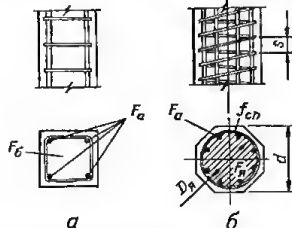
Армирование центрально сжатых железобетонных элементов: а — комутами (поперечными стержнями); б — спиральной арматурой
